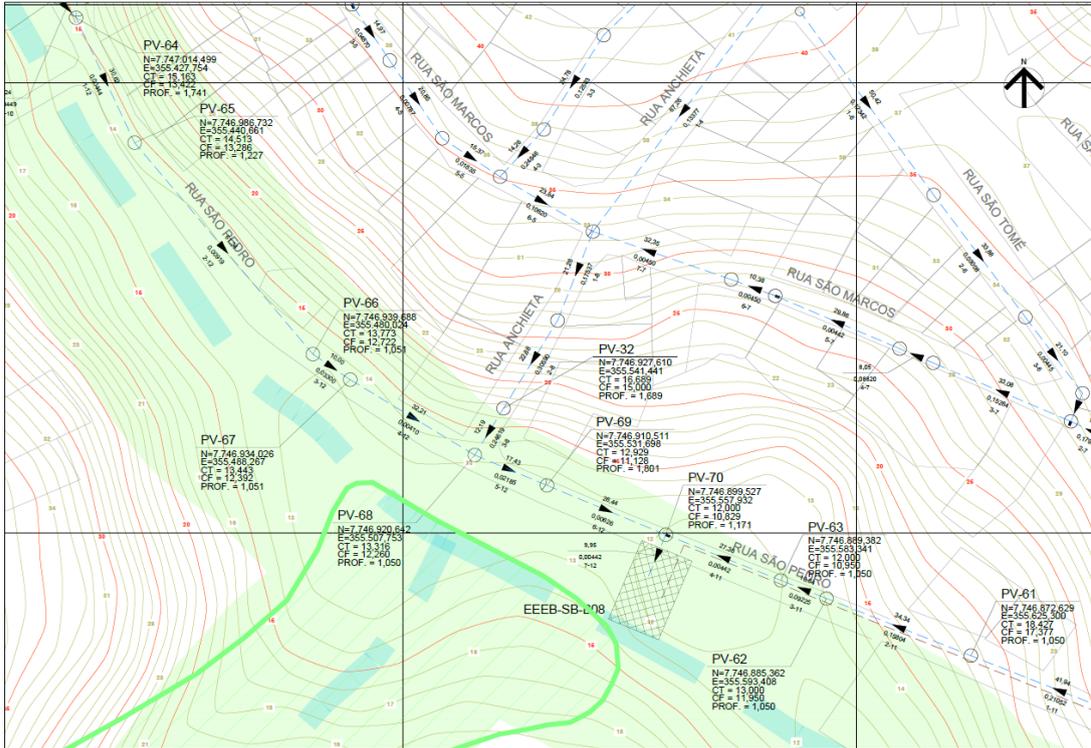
Estação elevatória de esgoto bruto EEEB-SB-B08, em área de APP.
